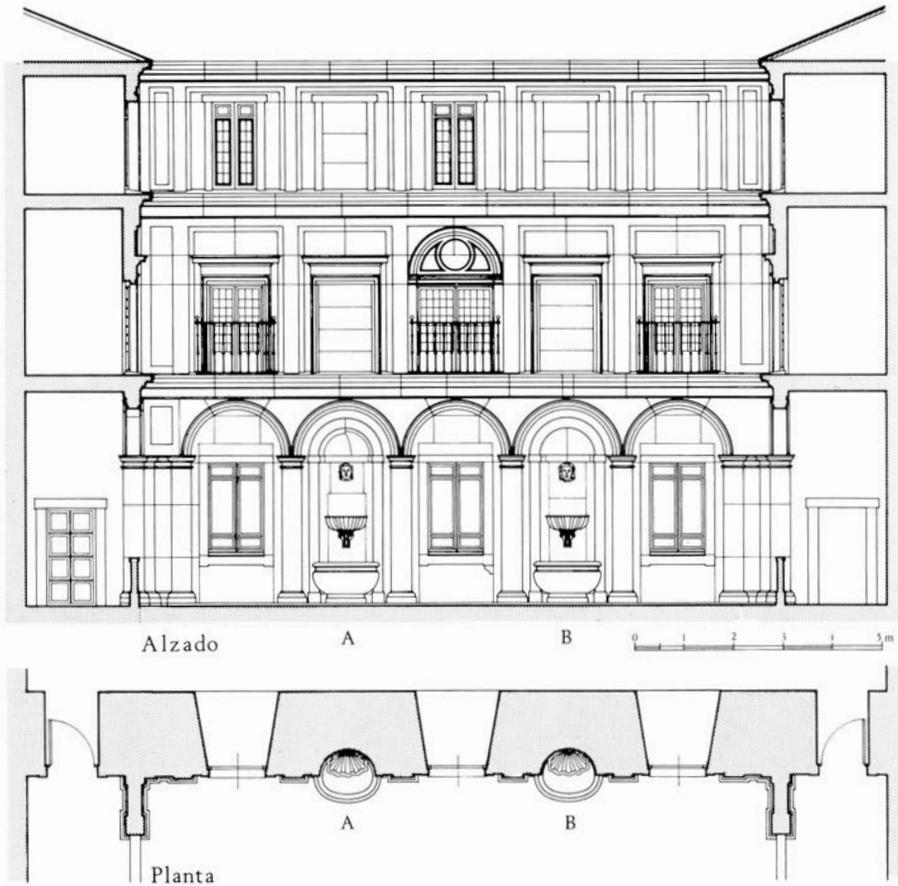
Alzado de la fachada que mira a Oriente en el Patio de la Casa Real.
